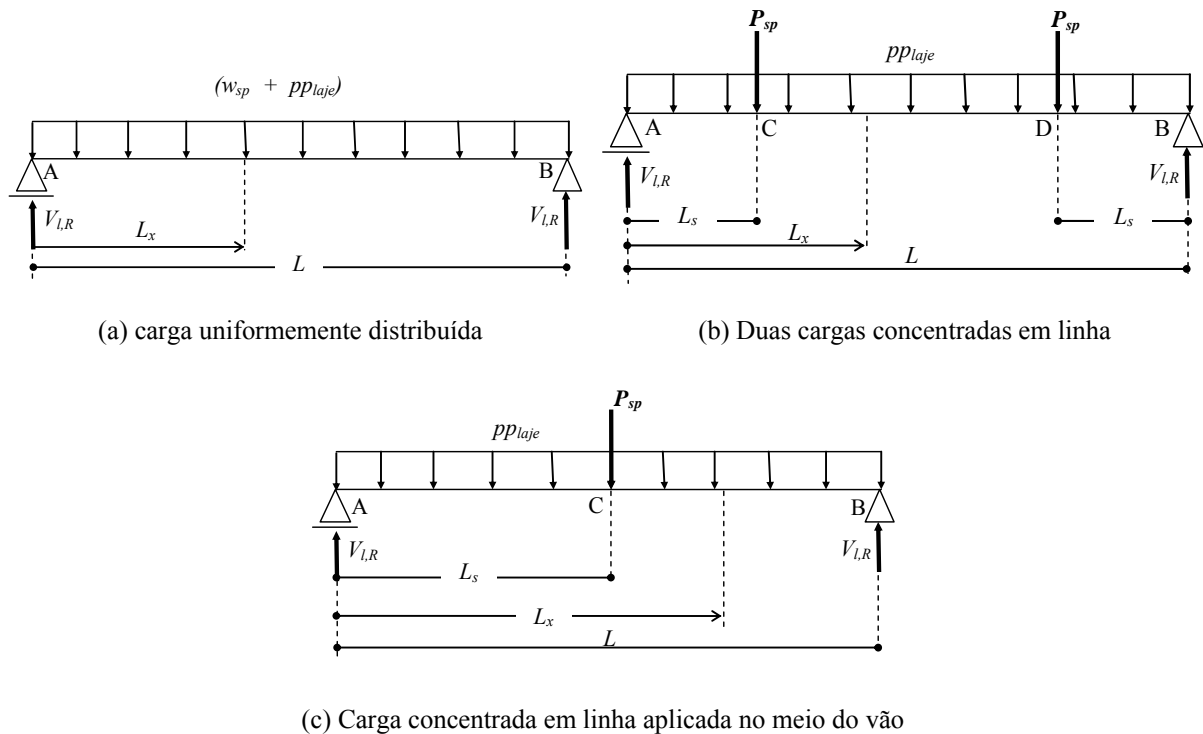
Tipos de carregamentos aplicados em uma viga biapoiada
